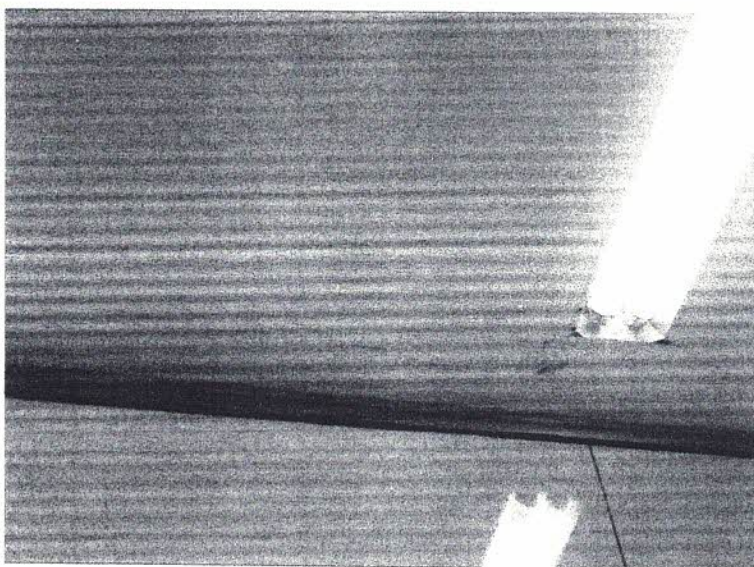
Fissuras no teto do banheiro masculino da Câmara Municipal.
